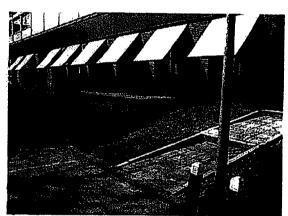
Het gebouw is hoger gelegen dan de omgeving
